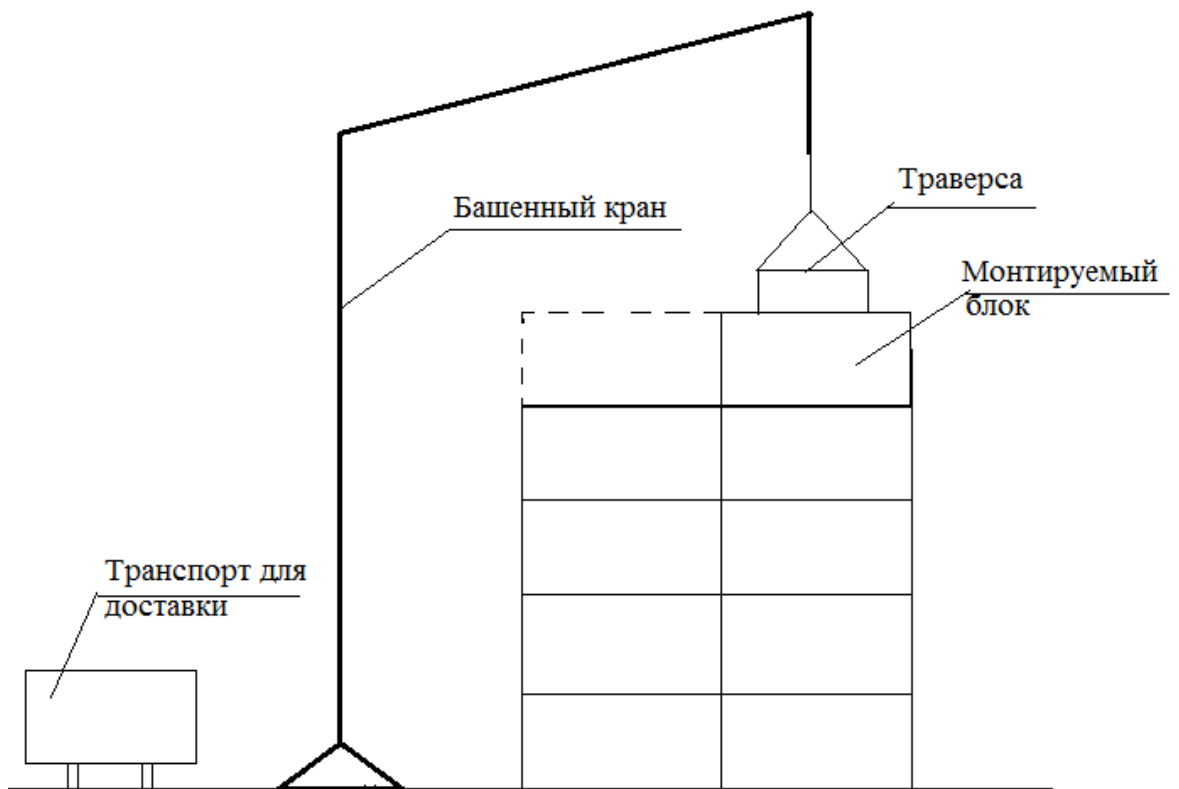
Монтаж зданий из объёмных блоков башенным краном
